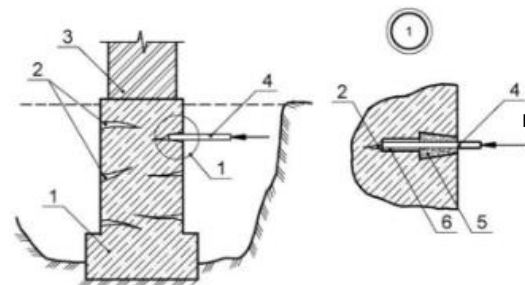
Восстановление несущей способности фундаментов путем закрепления бетонной (железобетонной) поверхности синтетическими смолами: 1 – существующий фундамент, имеющий вертикальные и горизонтальные трещины; 2 – трещины; 3 – кирпичная стена; 4 – иньектор для нагнетания компаунда из синтетических смол под давлением 0,6–1,2 МПа; 5 – борозда шириной 35–40 мм, выполненная дисковой пилой или отбойным молотком; 6 – отверстие, пробуренное перфоратором на глубину 100–150 мм
